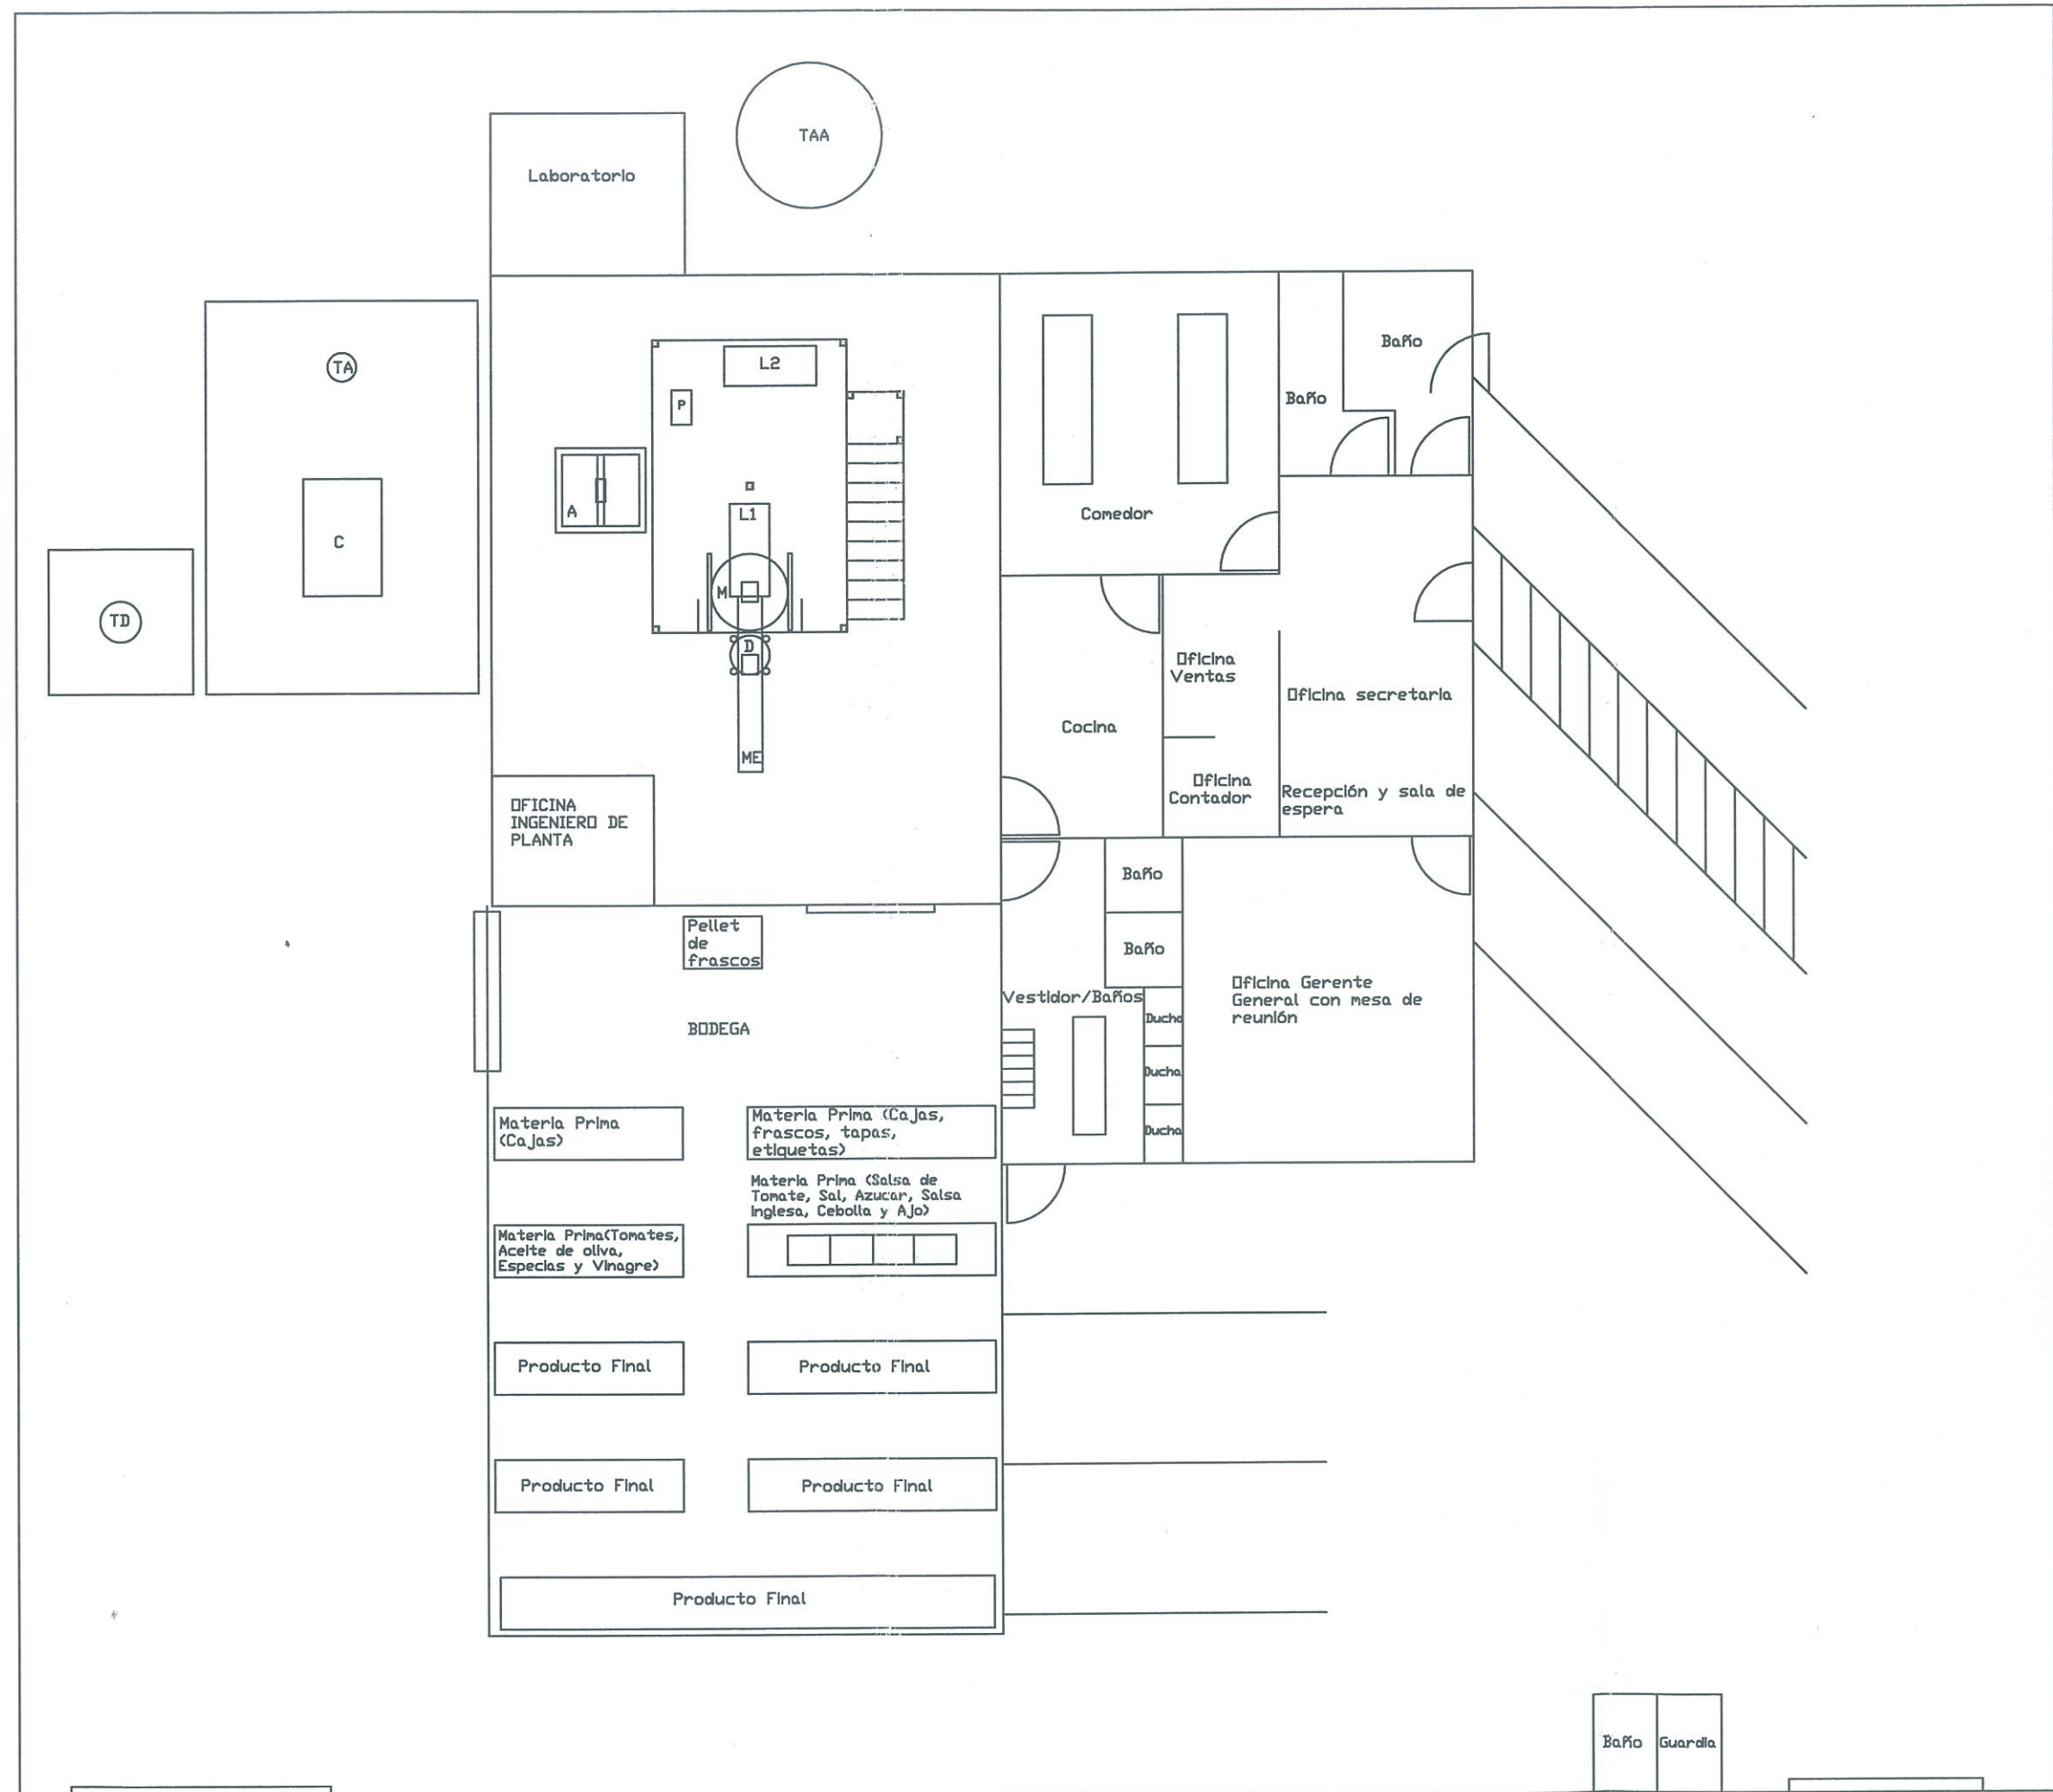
Vista Superior del Plano de la Planta Industrial
